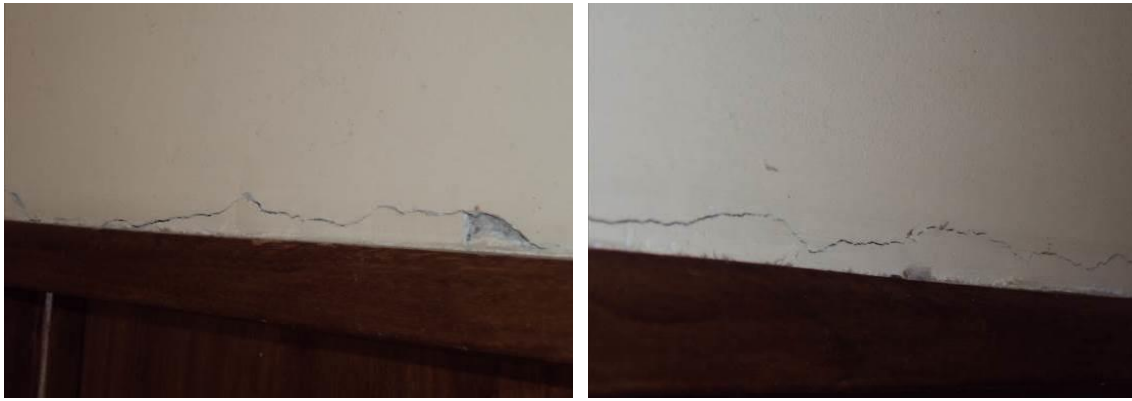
Fissuras ao longo de todo o vão das portas do corredor
